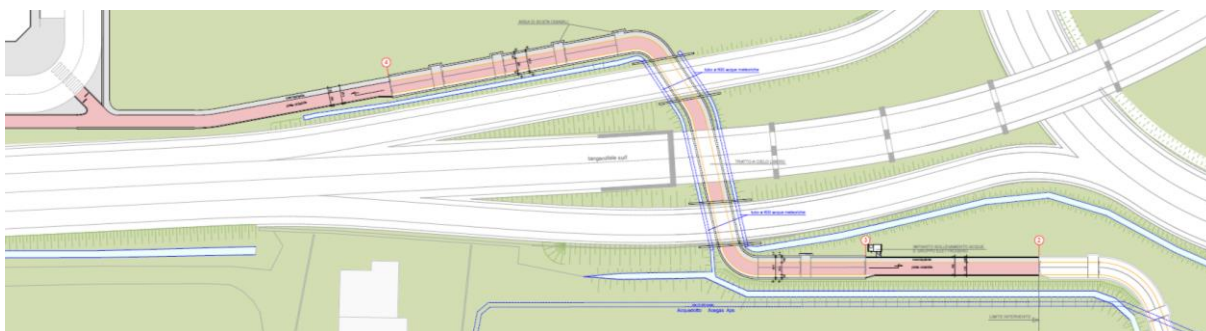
Planimetria di un tratto della pista ciclopeditonale prevista (Studio di Impatto Viabilistico 2016, Tavola C)
